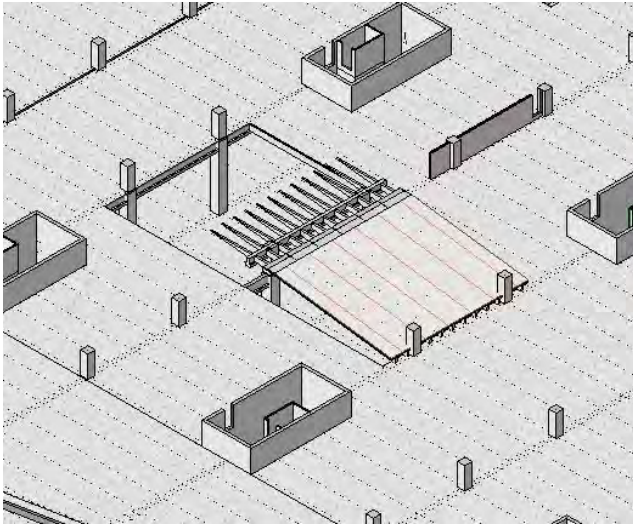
Gennemskinnelig beton med mellemliggende isolering
